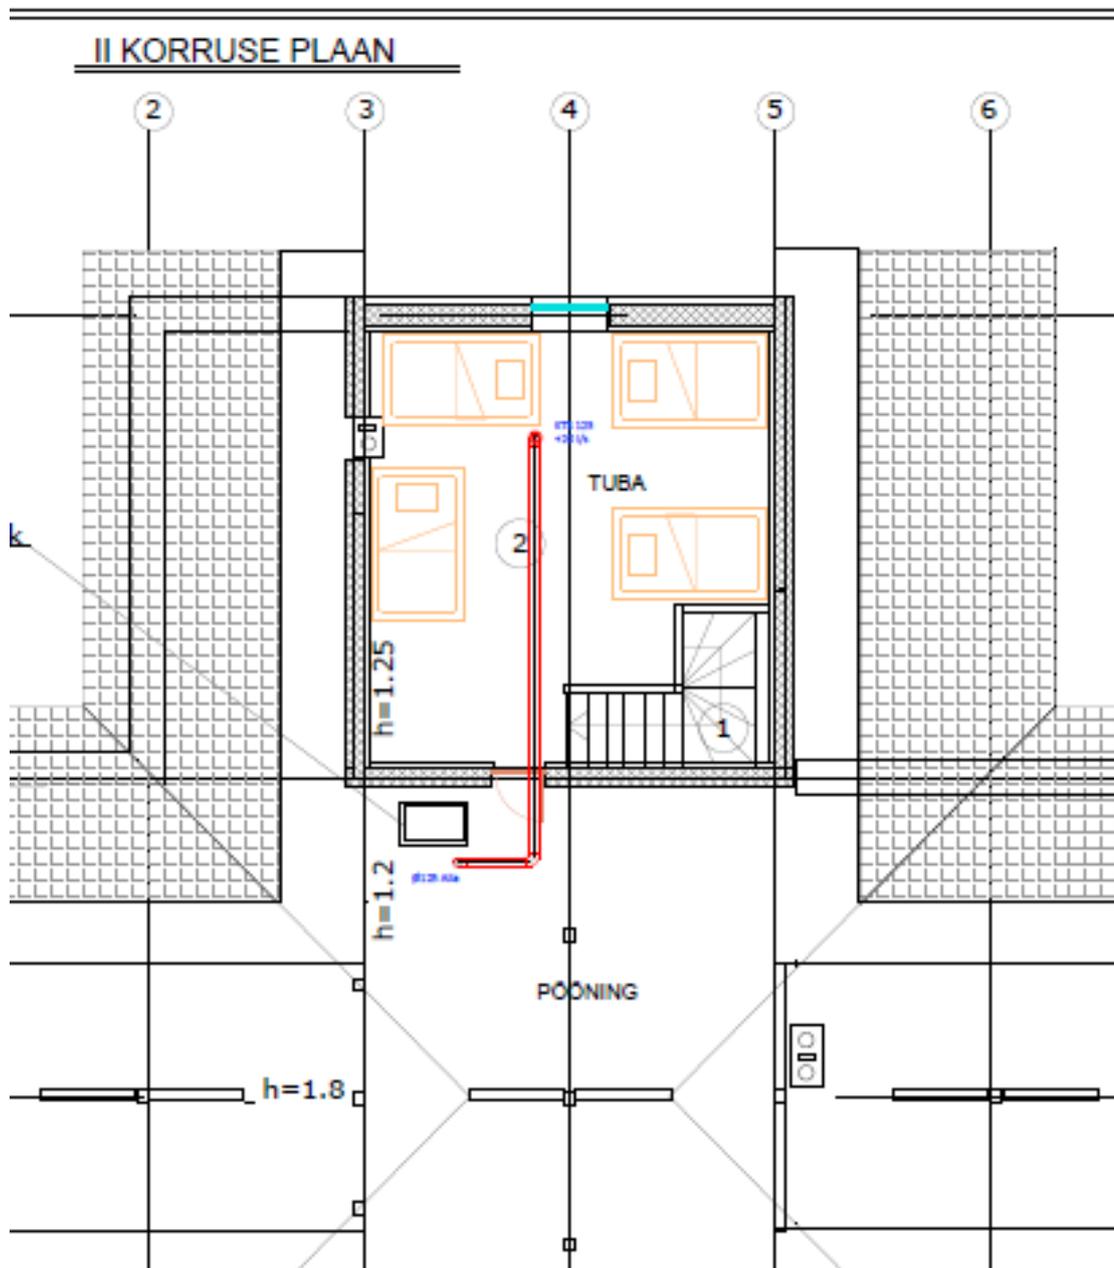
Схема прокладки воздуховодов приточно-вытяжной вентиляции на втором этаже дома
